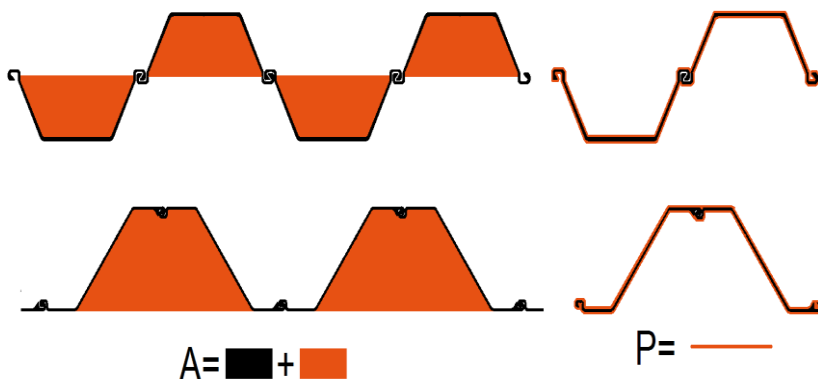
Площадь поперечного сечения – A и периметр поперечного сечения – P
